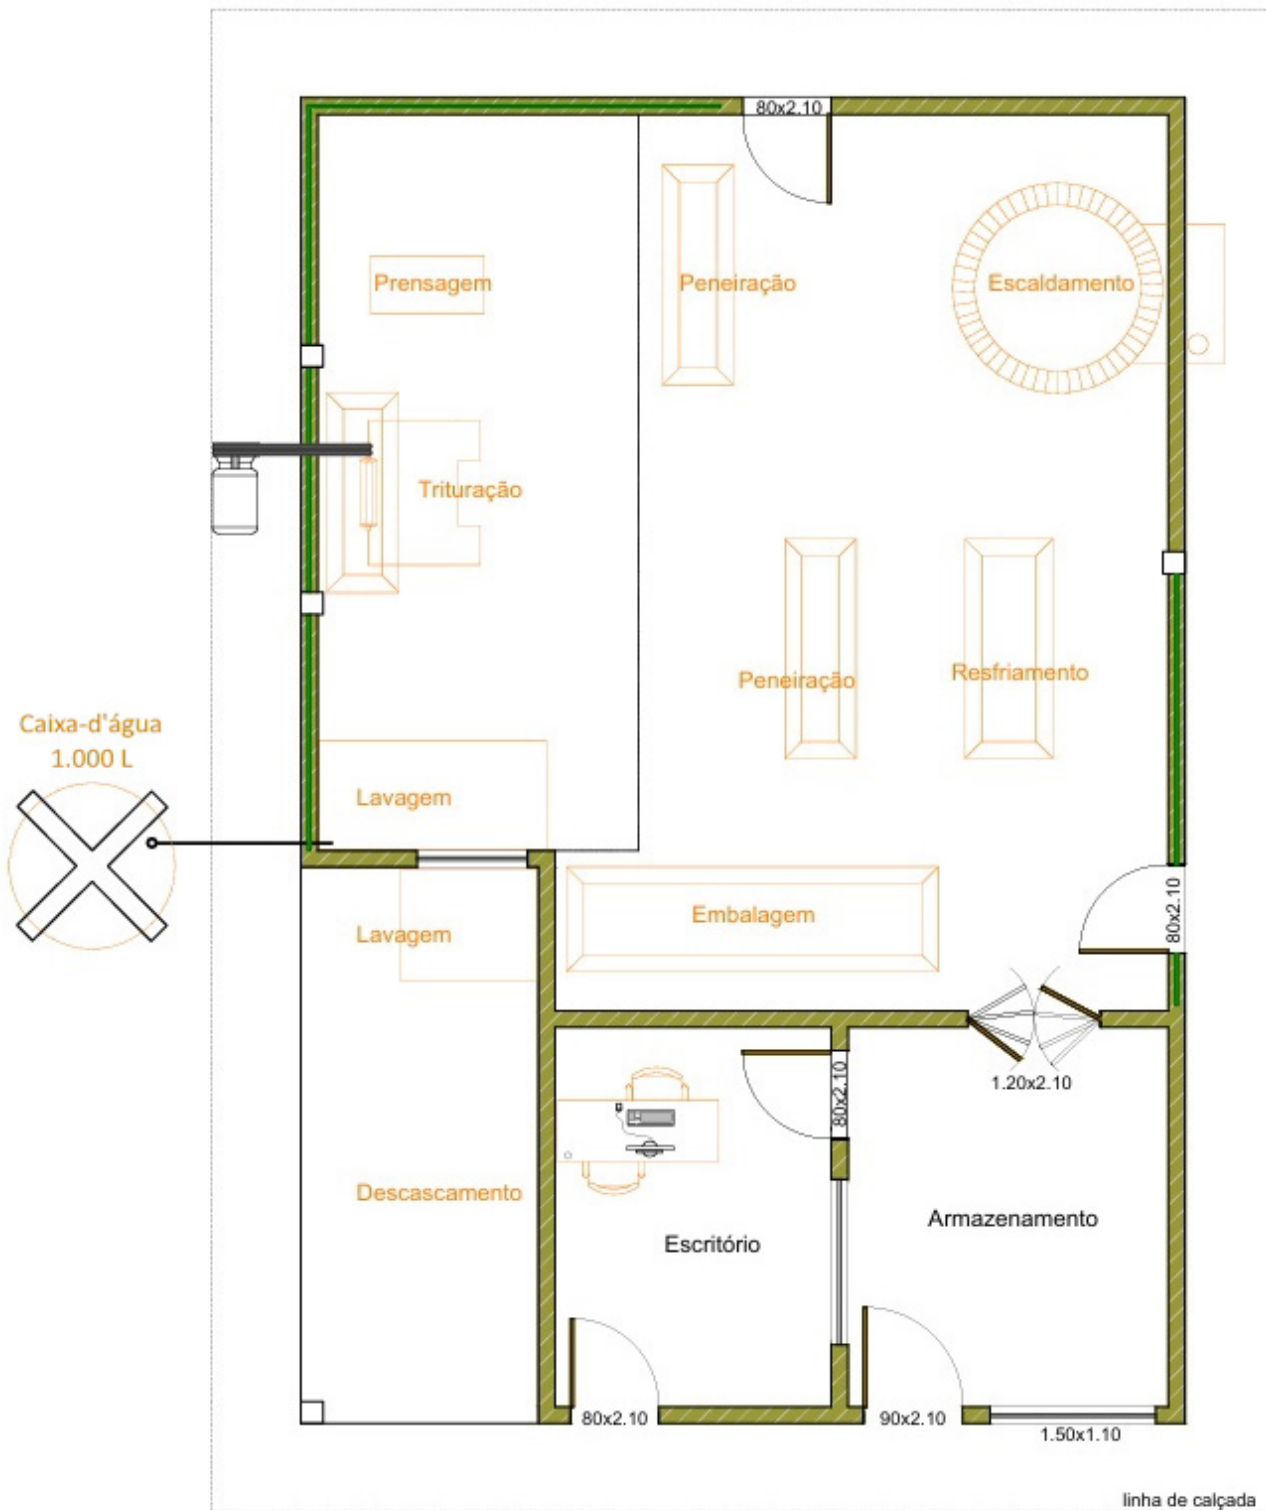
Planta baixa hidráulica da casa de farinha – escala 1:50.
